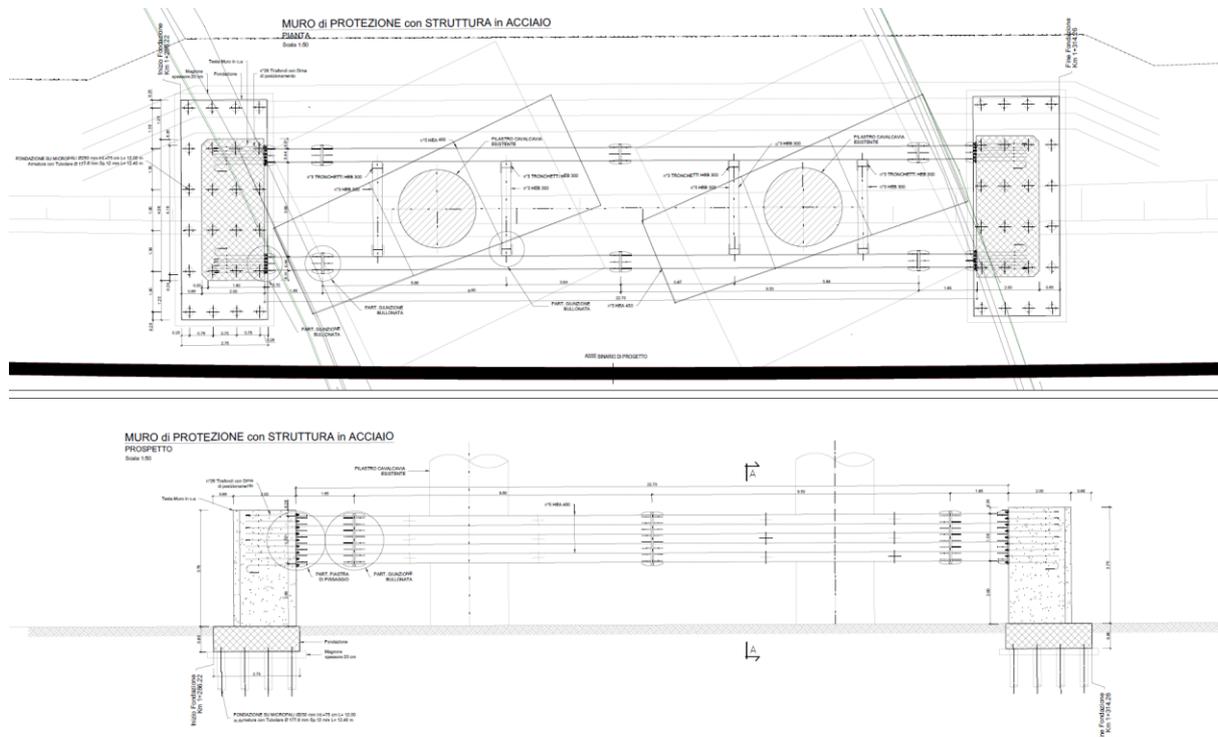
Opera di protezione cavalcaferrovia pk 1+300 (pianta e prospetto)
